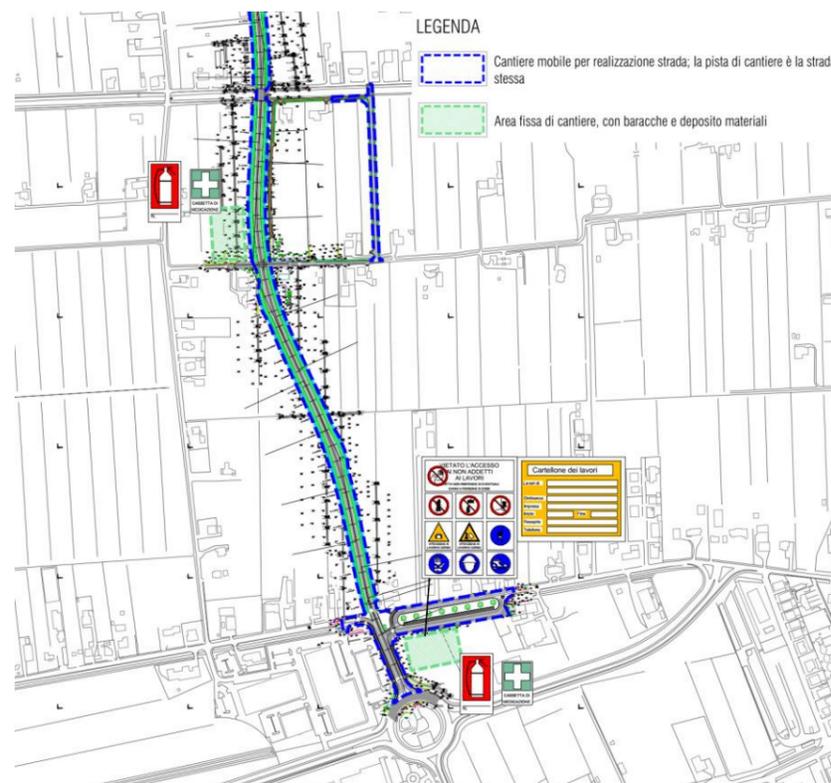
Estratto planimetria raffigurante le aree di cantiere a Sud del Cavetta.
